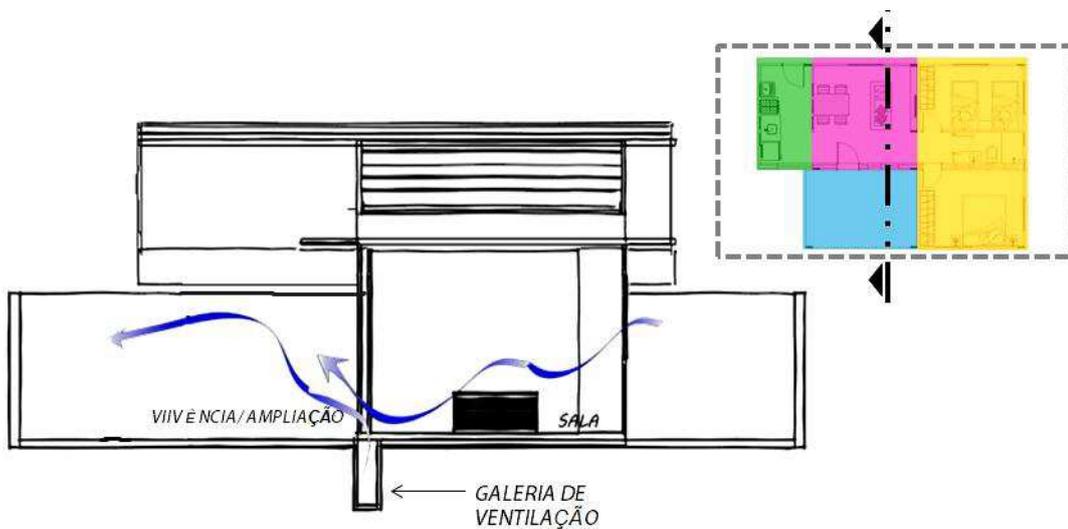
Corte Esquemático 03 – Galeria de ventilação auxiliando na circulação dos ventos.
